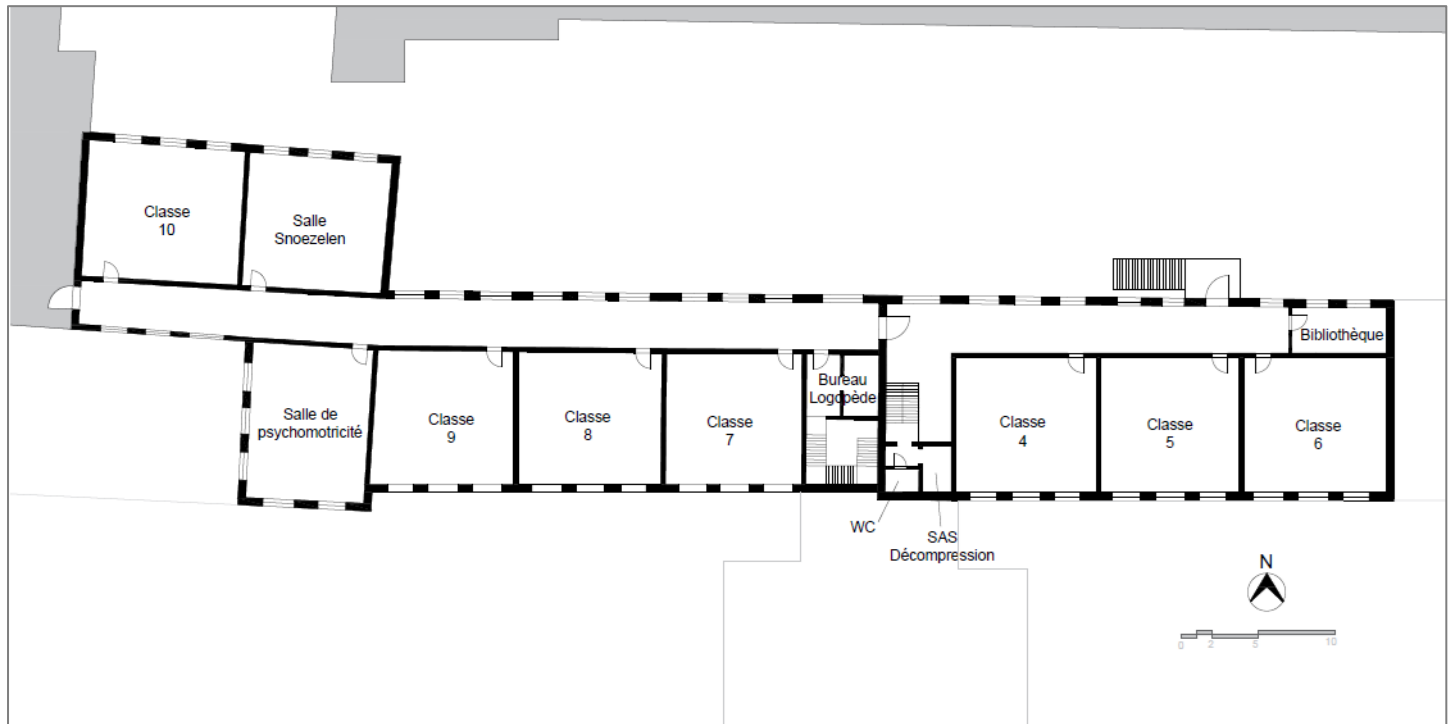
Plan du 1^{er} étage – La Colline de l'Éveil (Daumalle, 2026)
